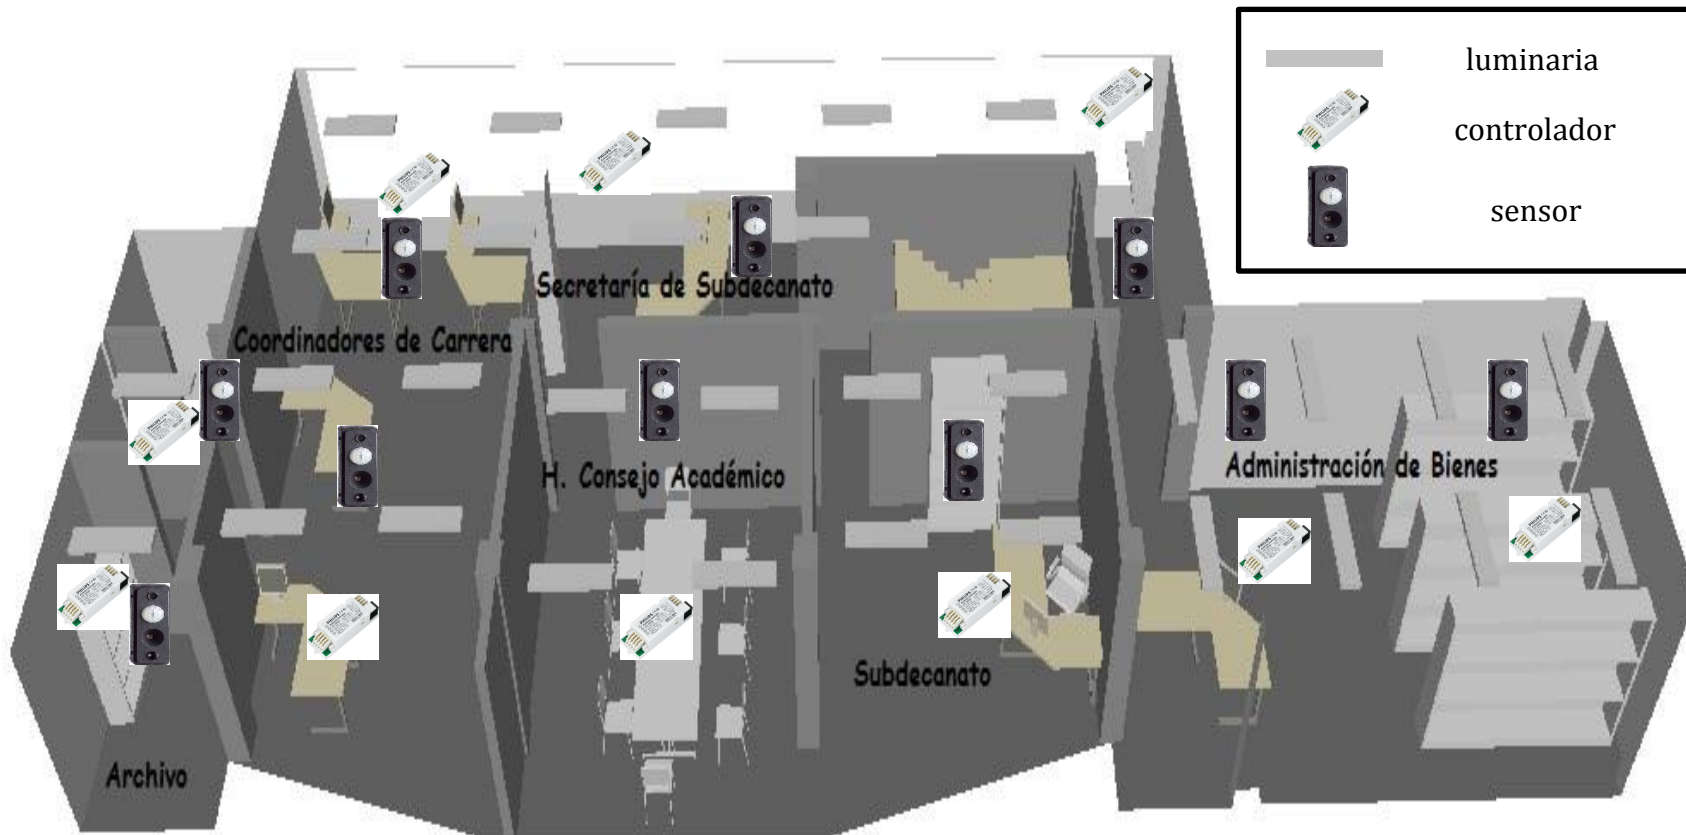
Plano tipo Y Distribución de los equipos segundo piso
